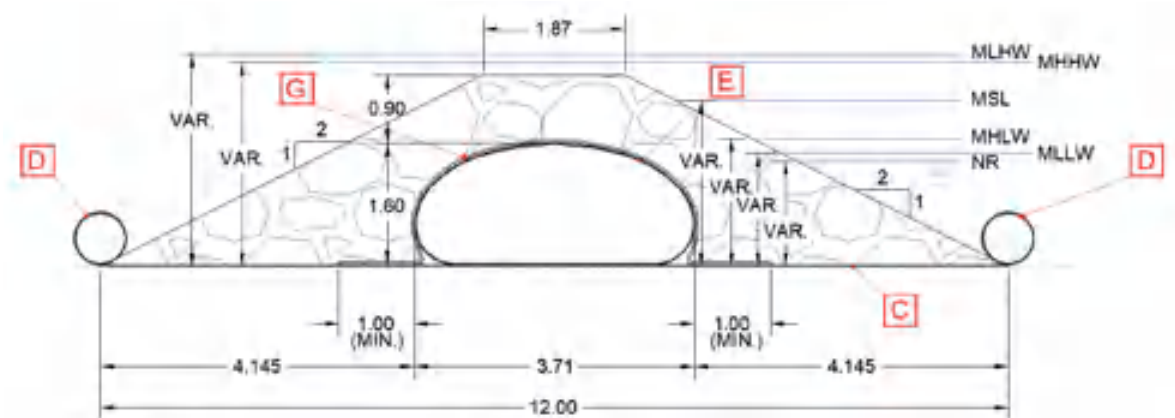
Seção transversal do segmento transversal da obra-piloto em seu trecho emerso. Fonte: Garcia e Gireli, 2019.
